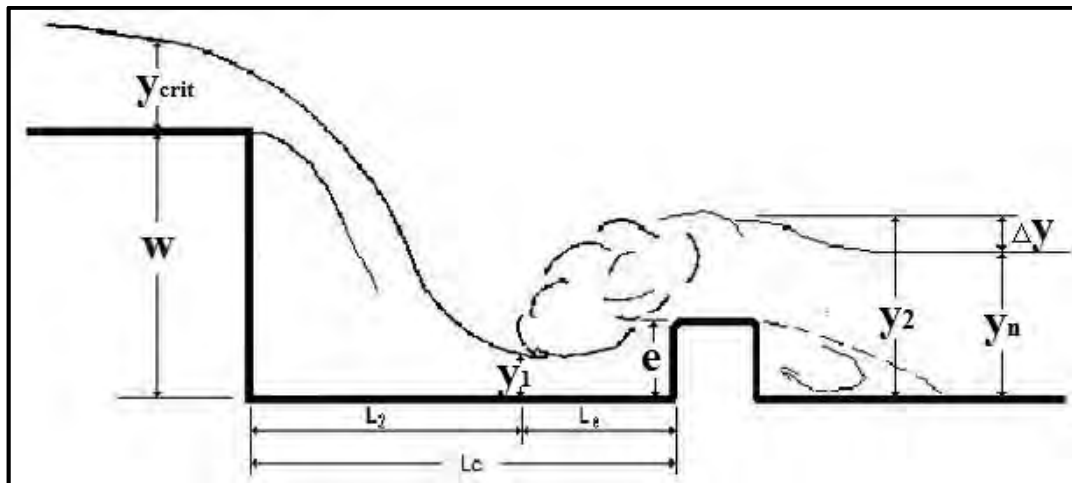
Colchón hidráulico con travesaño de fondo.
